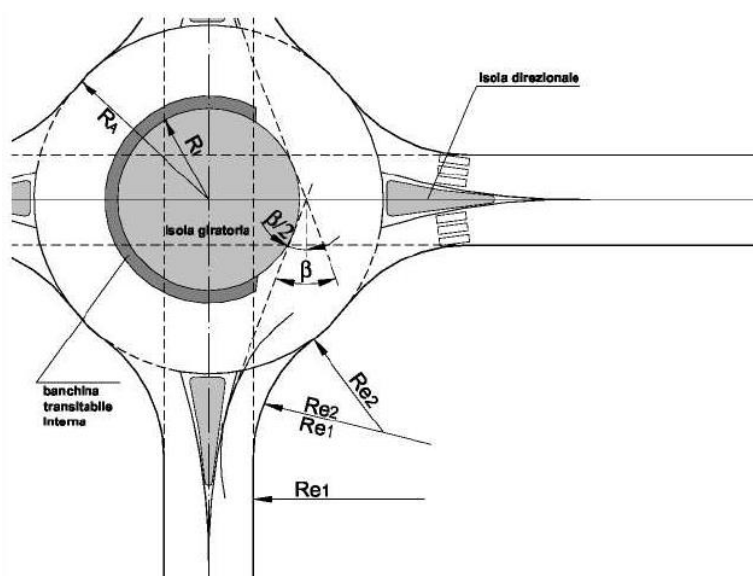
elementi di progetto e tipizzazione delle rotatorie.
